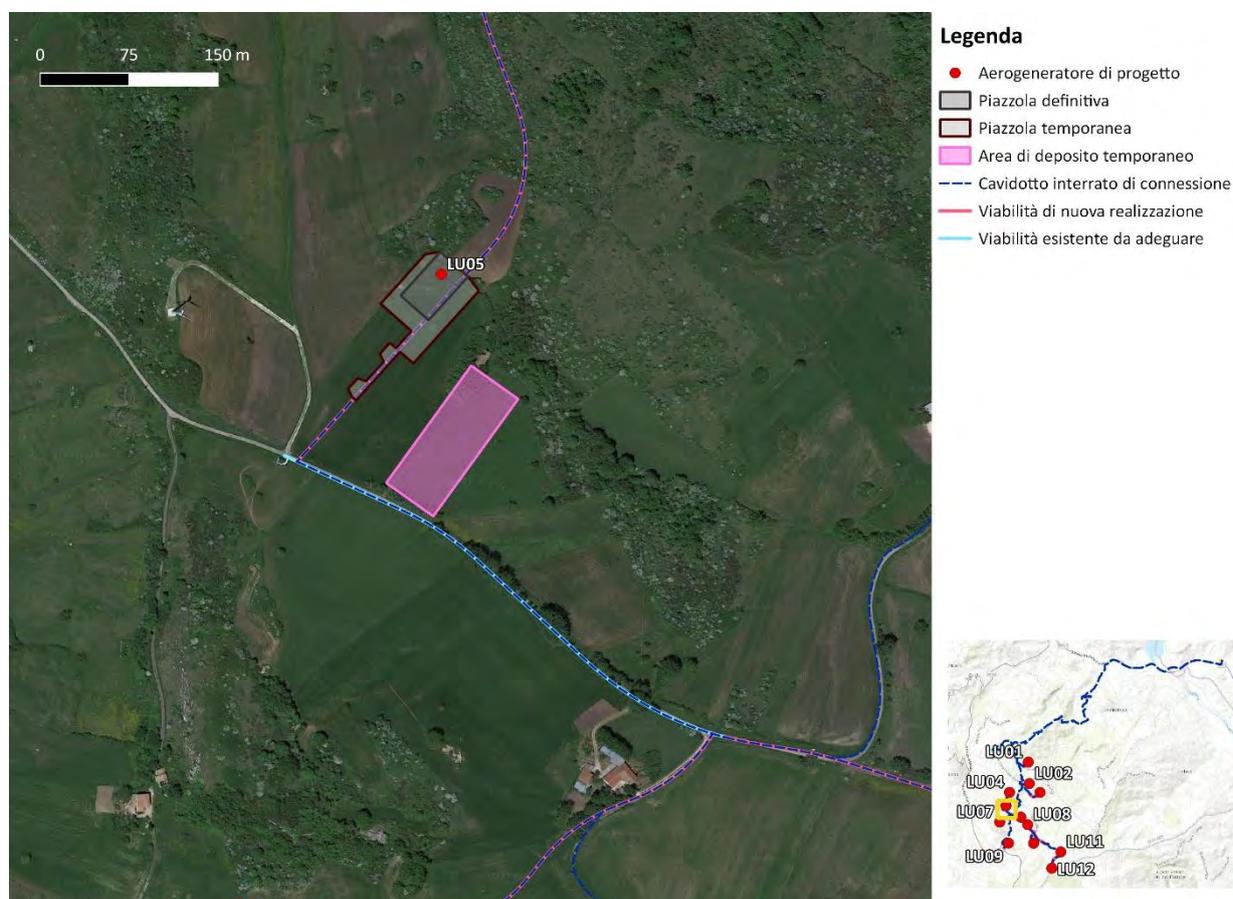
Localizzazione dell'area di deposito temporaneo per la fase di cantiere all'interno dell'impianto.
